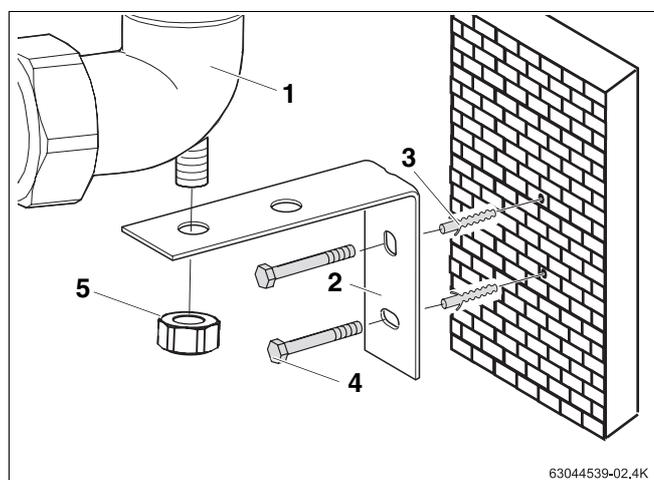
Wandhalter montieren (Darstellung ohne hintere Wärmedämmschale)
